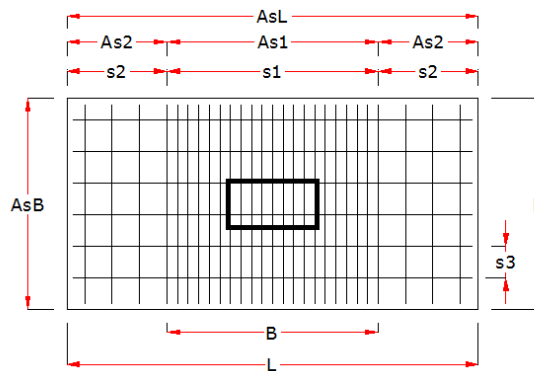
Distribución de armadura zapata de planta rectangular en 2 direcciones. Fuente: elaboración propia.
